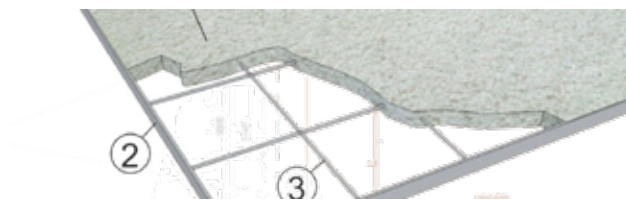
Detalle de Concreto Proyectado sobre Malla Truckson, Para Frisado Final. Fuente: <http://jmiguelsan.blogspot.com/2015/01/llega-conliven-paneles-de-concreto.html> (2015)
